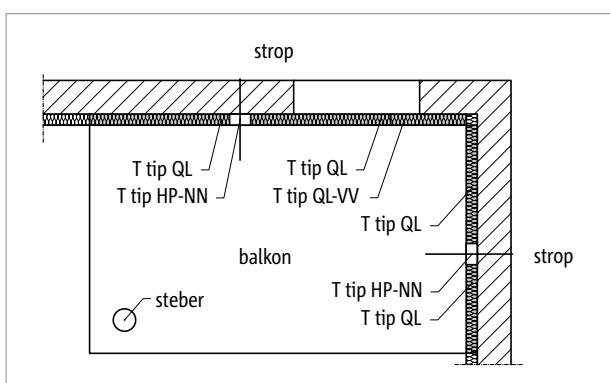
Schöck Isokorb® T tip HP: balkon z ležajenjem na stebrih
